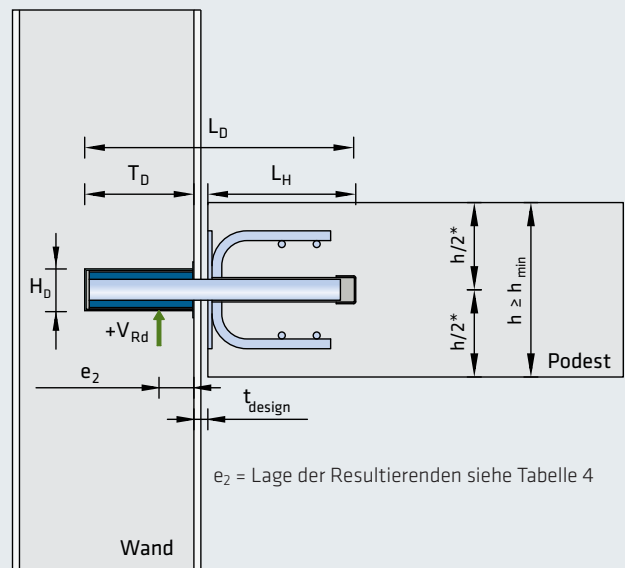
Beispiel für Wandanschluss PD30 SL zu Podest
